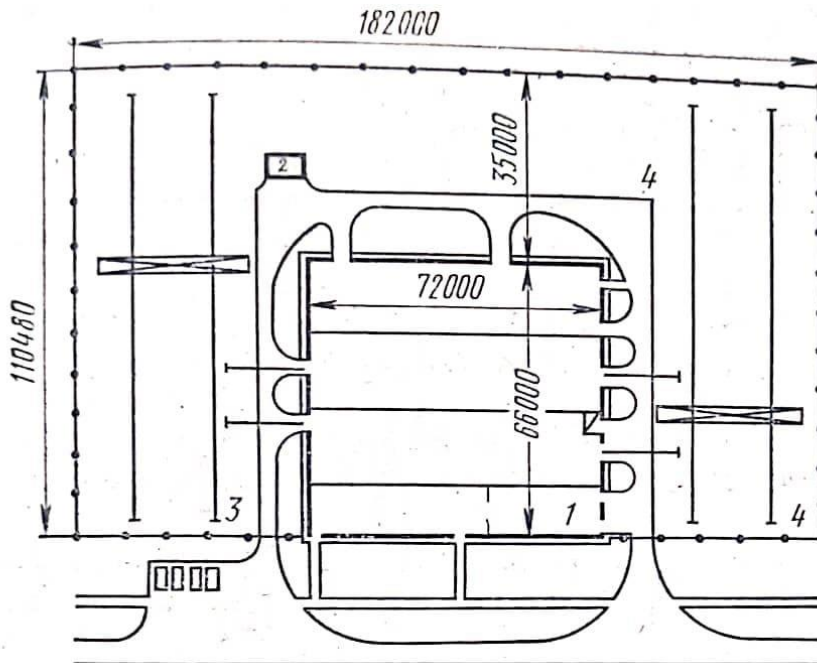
Схема генерального плану бази монтажних та спеціалізованих організацій
